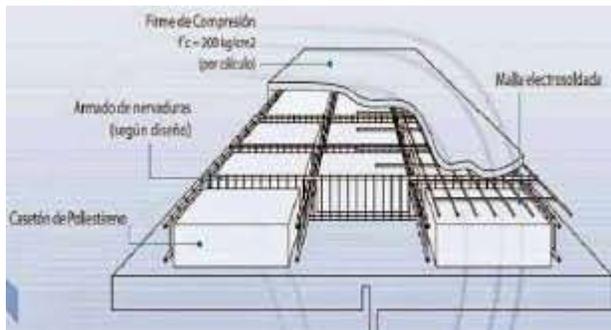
, 1.33, 1.34 y 1.35 Material prefabricado. casetón utilizado en losa.
